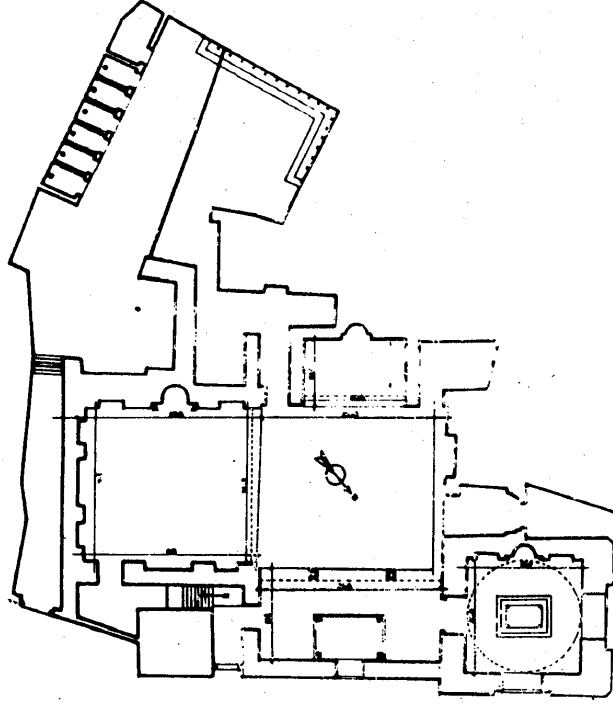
مسقط أفقي لجامع سيدى مدين بالقاهرة
